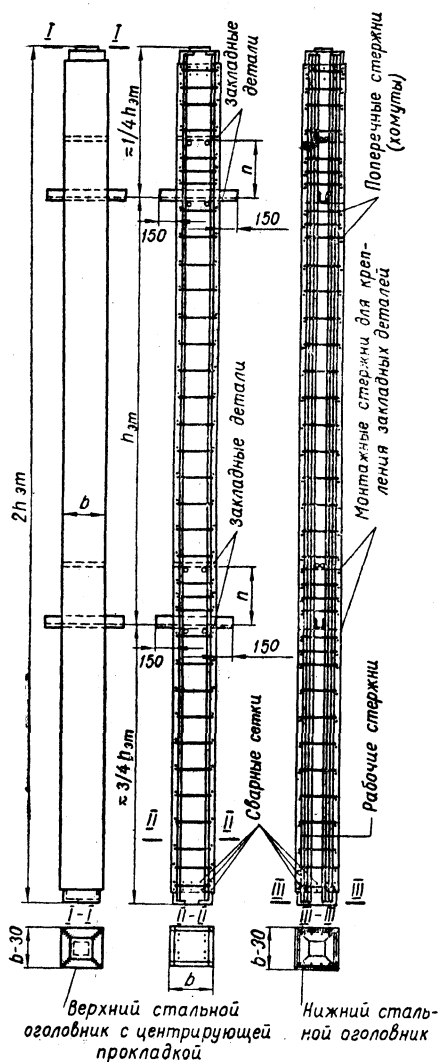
Схема армирования двухъярусной стойки сварными каркасами.
